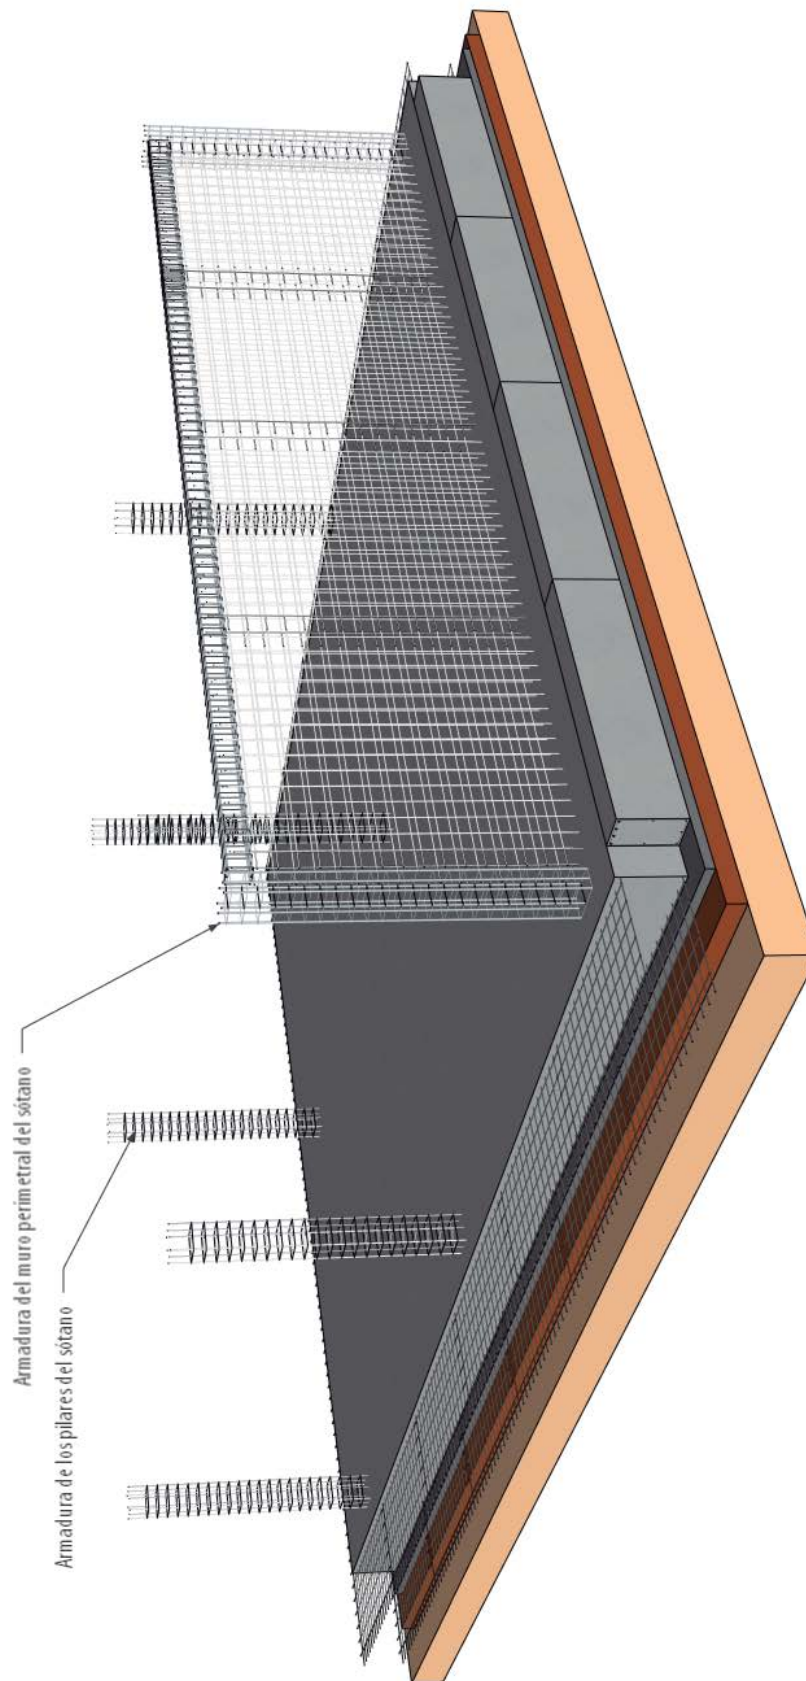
Colocación de las armadura de los pilares y muro perimetral de la planta sótano.
